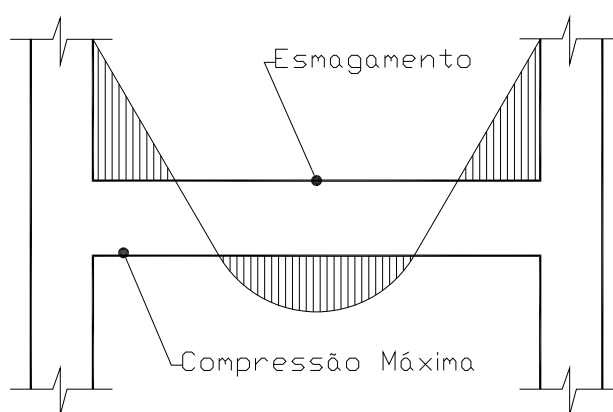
Fissuras ou rupturas por compressão, fonte HELENE 2003
